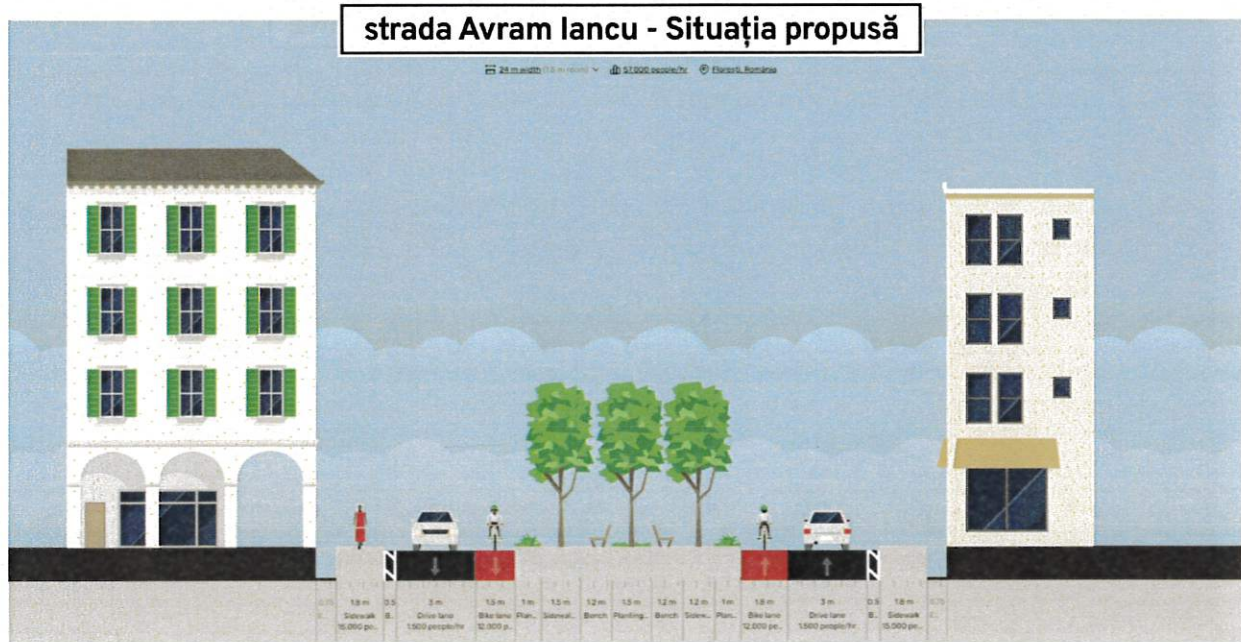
Profil transversal tip - Str. Avram Iancu situație propusă
